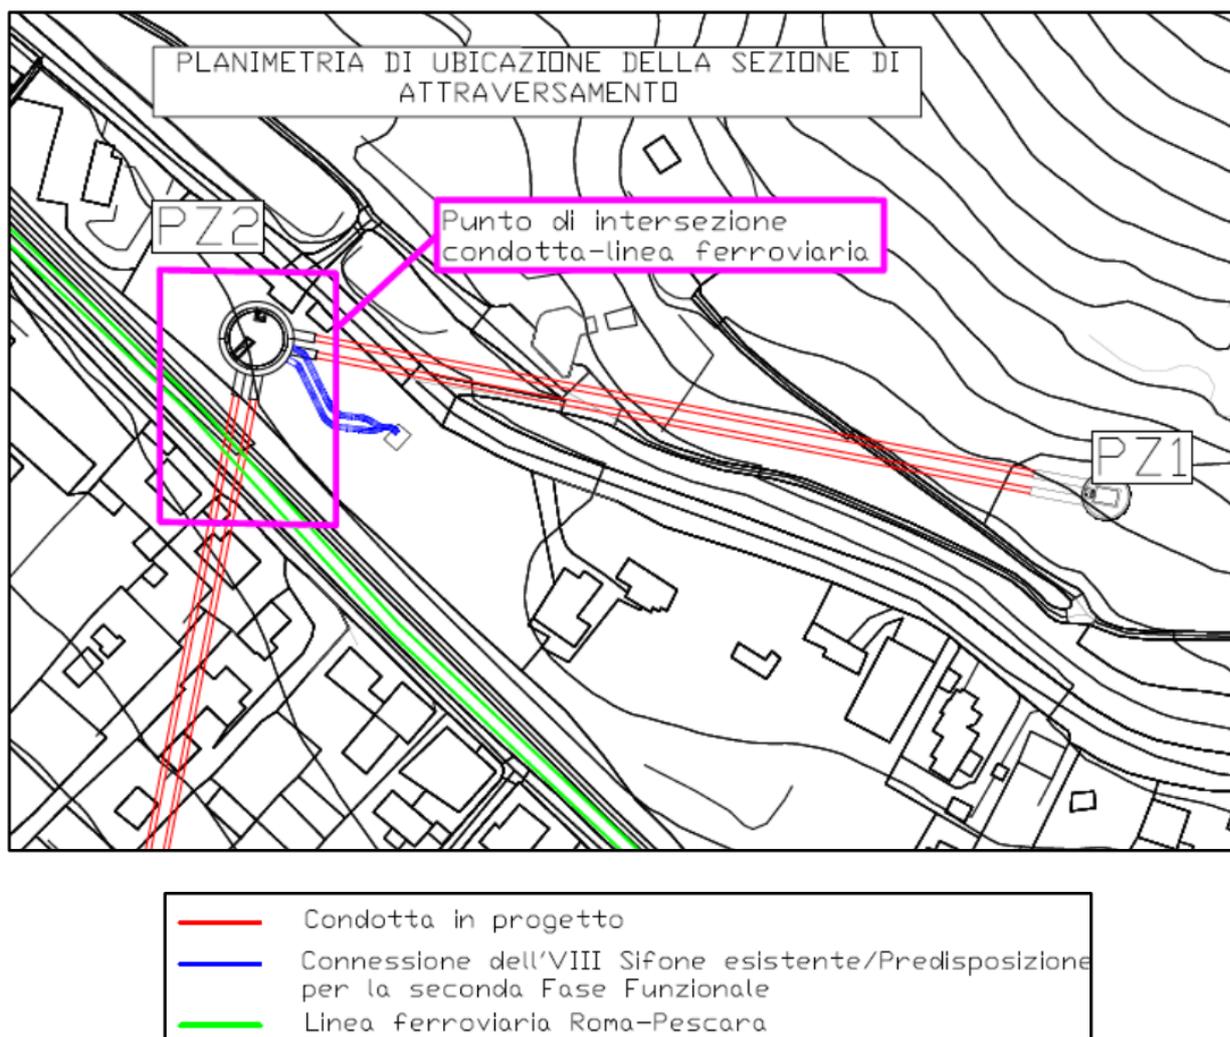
Planimetria con ubicazione del punto di attraversamento della tratta ferroviaria Roma-Pescara
